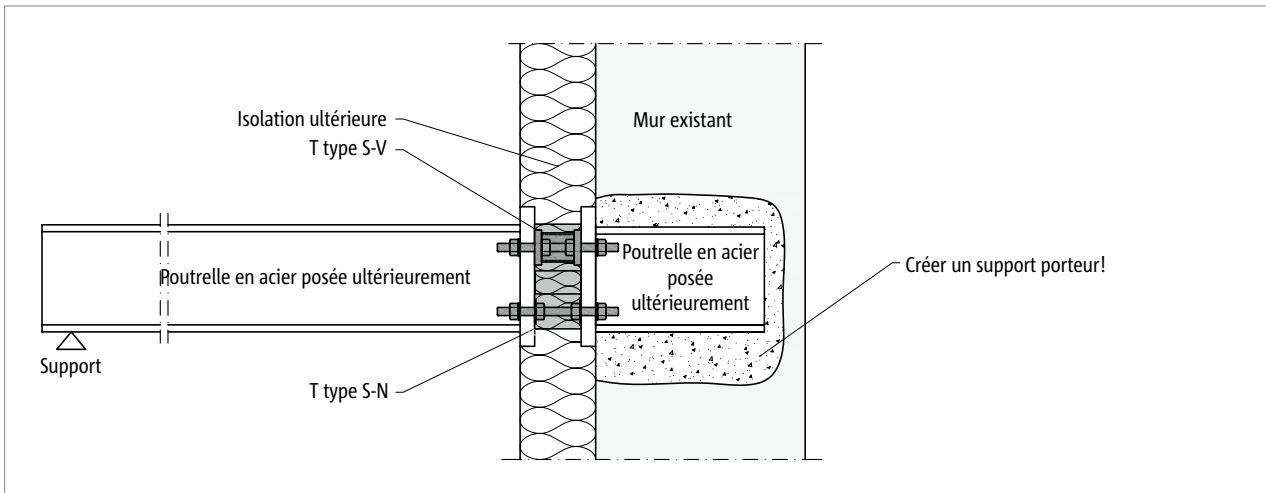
Schöck Isokorb® T type S-N et T type S-V : balcon en acier soutenu posé ultérieurement ; raccordé à un support mural posé ultérieurement
